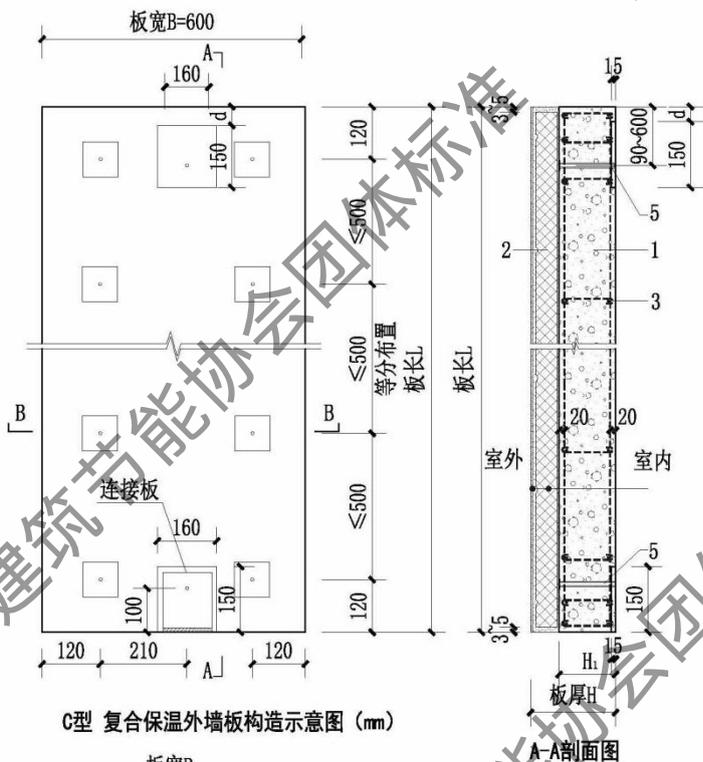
C 型复合保温外墙板基本构造示意图 (mm)
